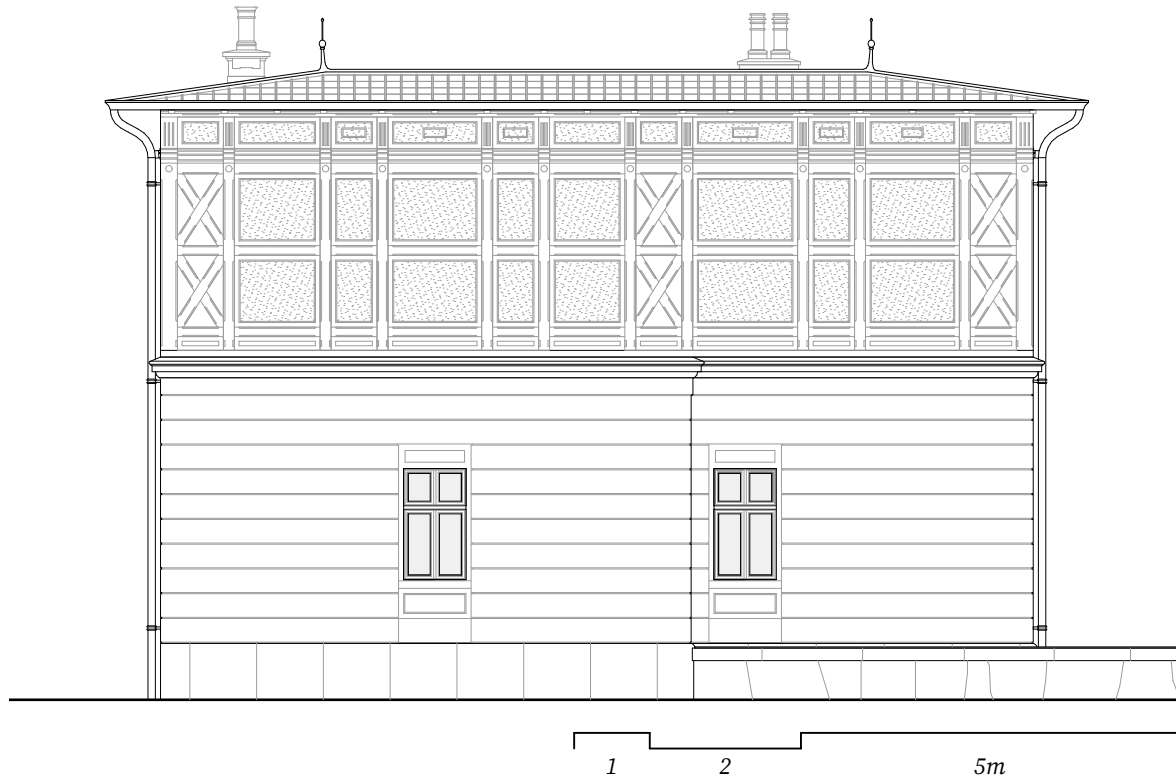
Stw Meidling Hauptstraße, Wien, Baujahr 1898 (ÖStA)
